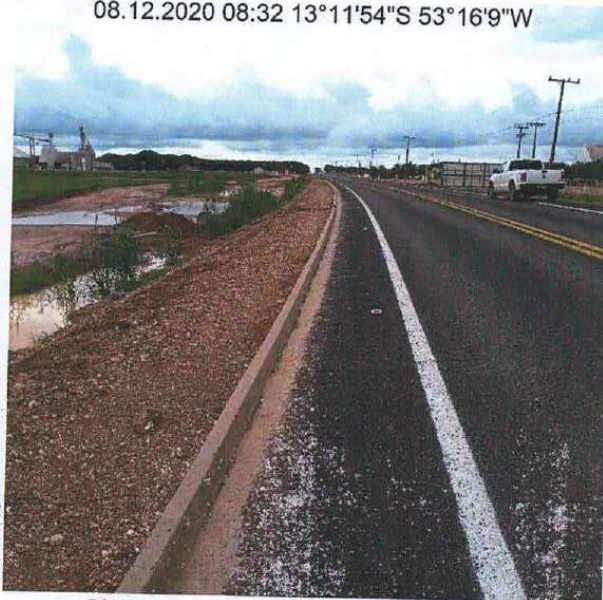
DETALHE DO MEIO-FIO IMPLANTADO
